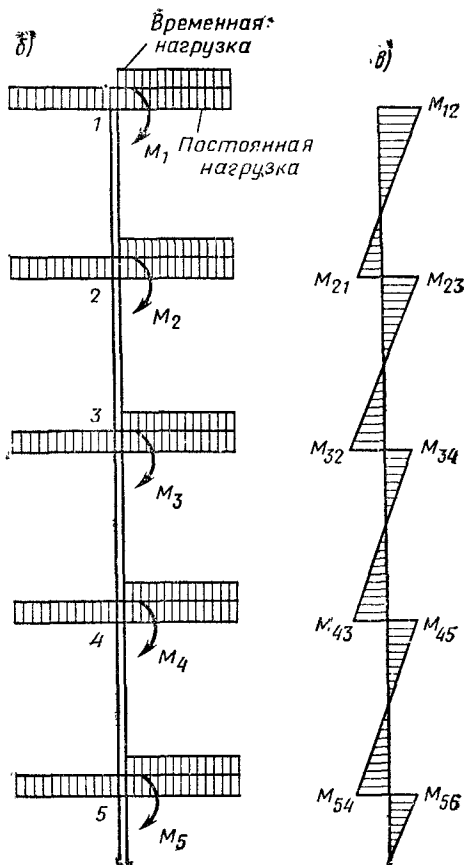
К расчету рамы на вертикальную нагрузку
